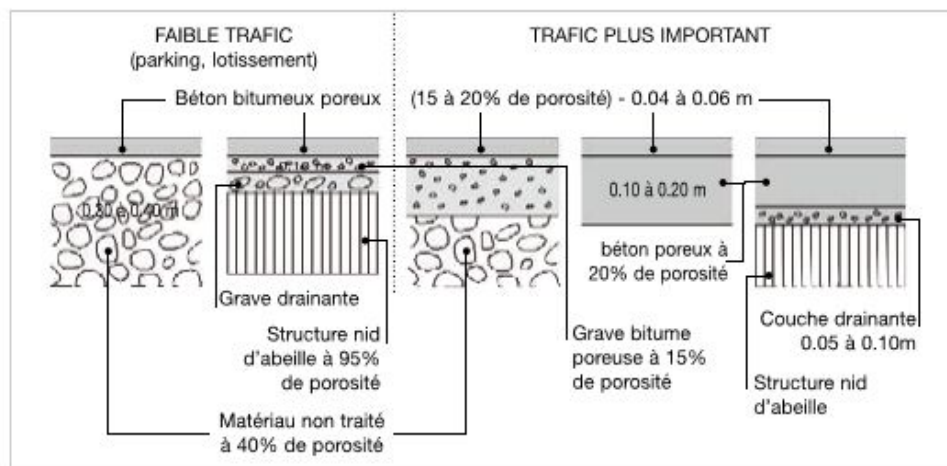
Dimensionnement de chaussées à structure réservoir avec enrobé drainant en fonction du trafic (Source Cete du Sud-Ouest)
